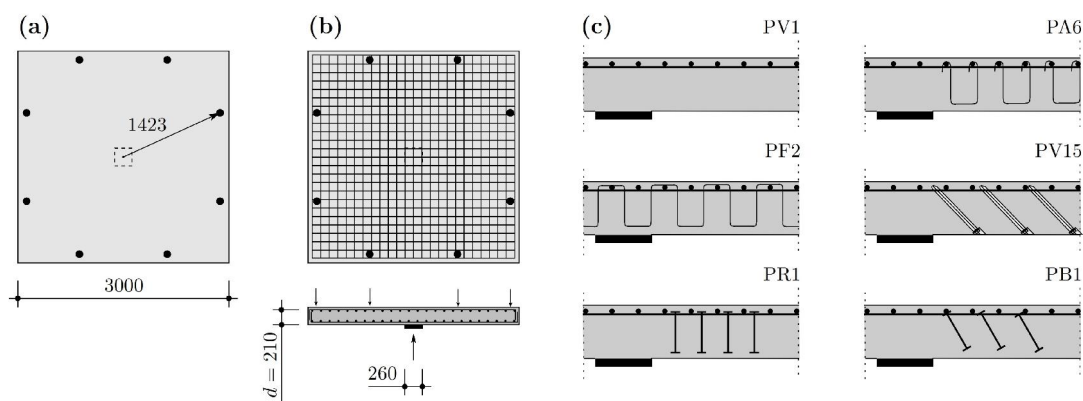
Lajes ensaiadas: (a) geometria; (b) armadura de flexão ($\rho=1,50\%$); (c) sistemas de armaduras de punçoamento [65].
